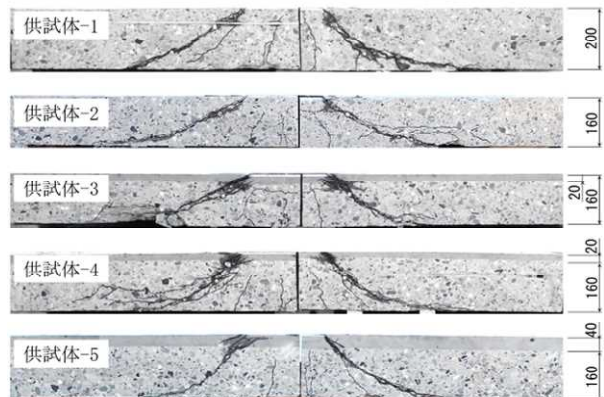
ひび割れ断面状況 (橋軸直角方向)
